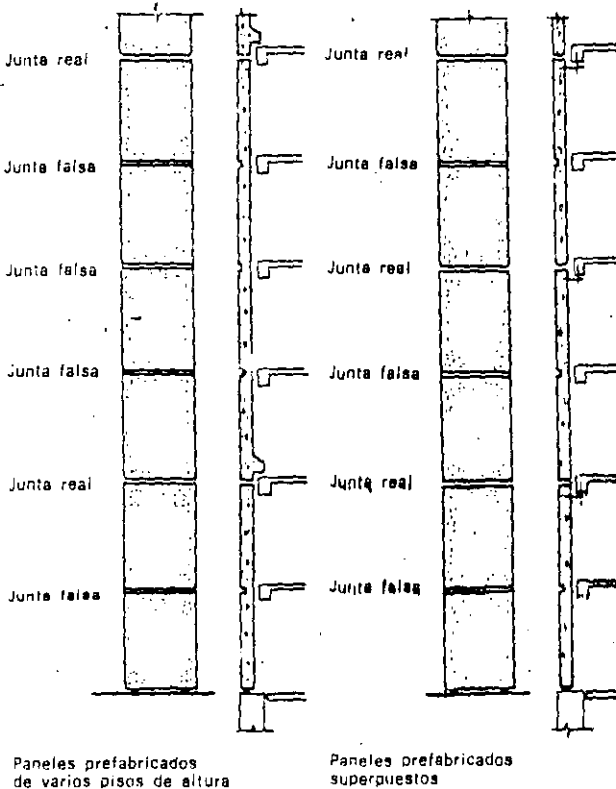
ELEMENTOS PREFABRICADOS PARA EDIFICIOS CON PLACAS DE FORJADO EN VOLADIZO
